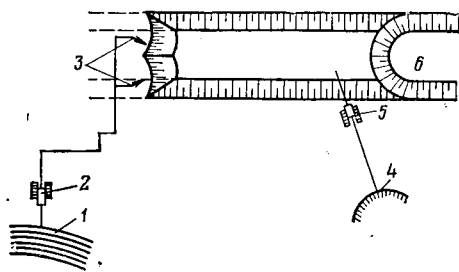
Схема выторфовывания попутным забоем при возведении насыпи на болоте I типа
